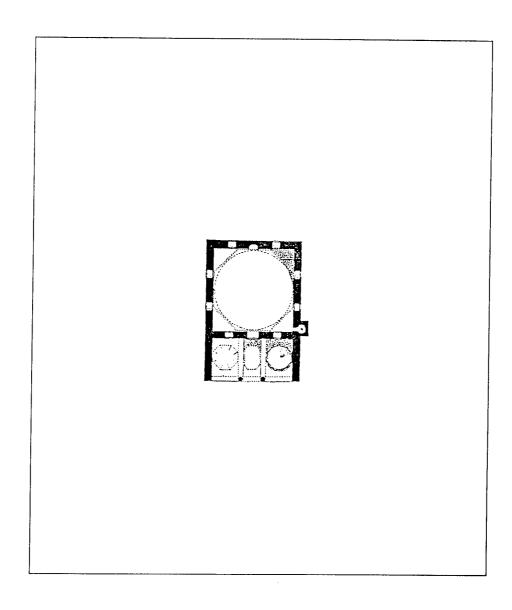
مسقط أفقي لمسجد فيروز اغا في استانبول (عن : جابرييل) .
